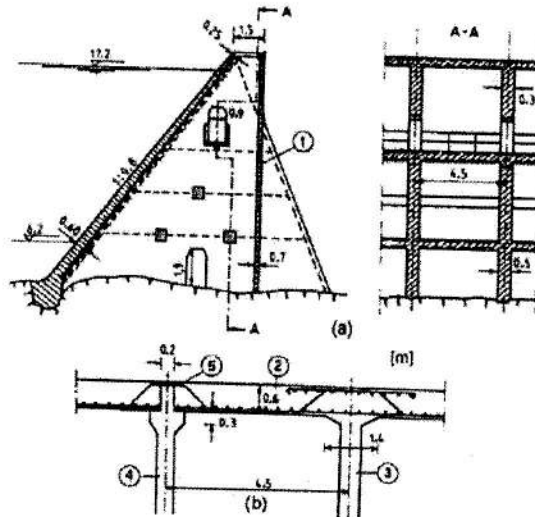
Détail des éléments d'un barrage contrefort
